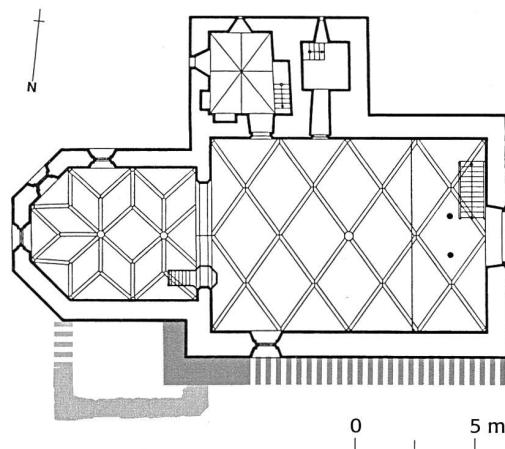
Sta. Maria V. M., evangelische Kirche, Sanierung Friedhof. Grundriss der Kirche von 1492 mit den Mauerbefunden.
